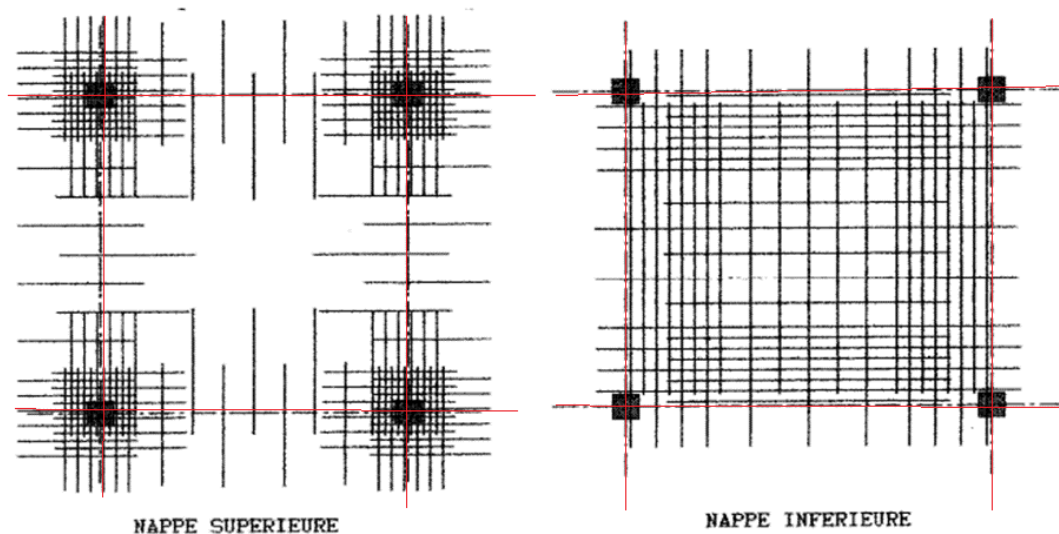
Dispositions d'armatures plancher-dalle [4].
